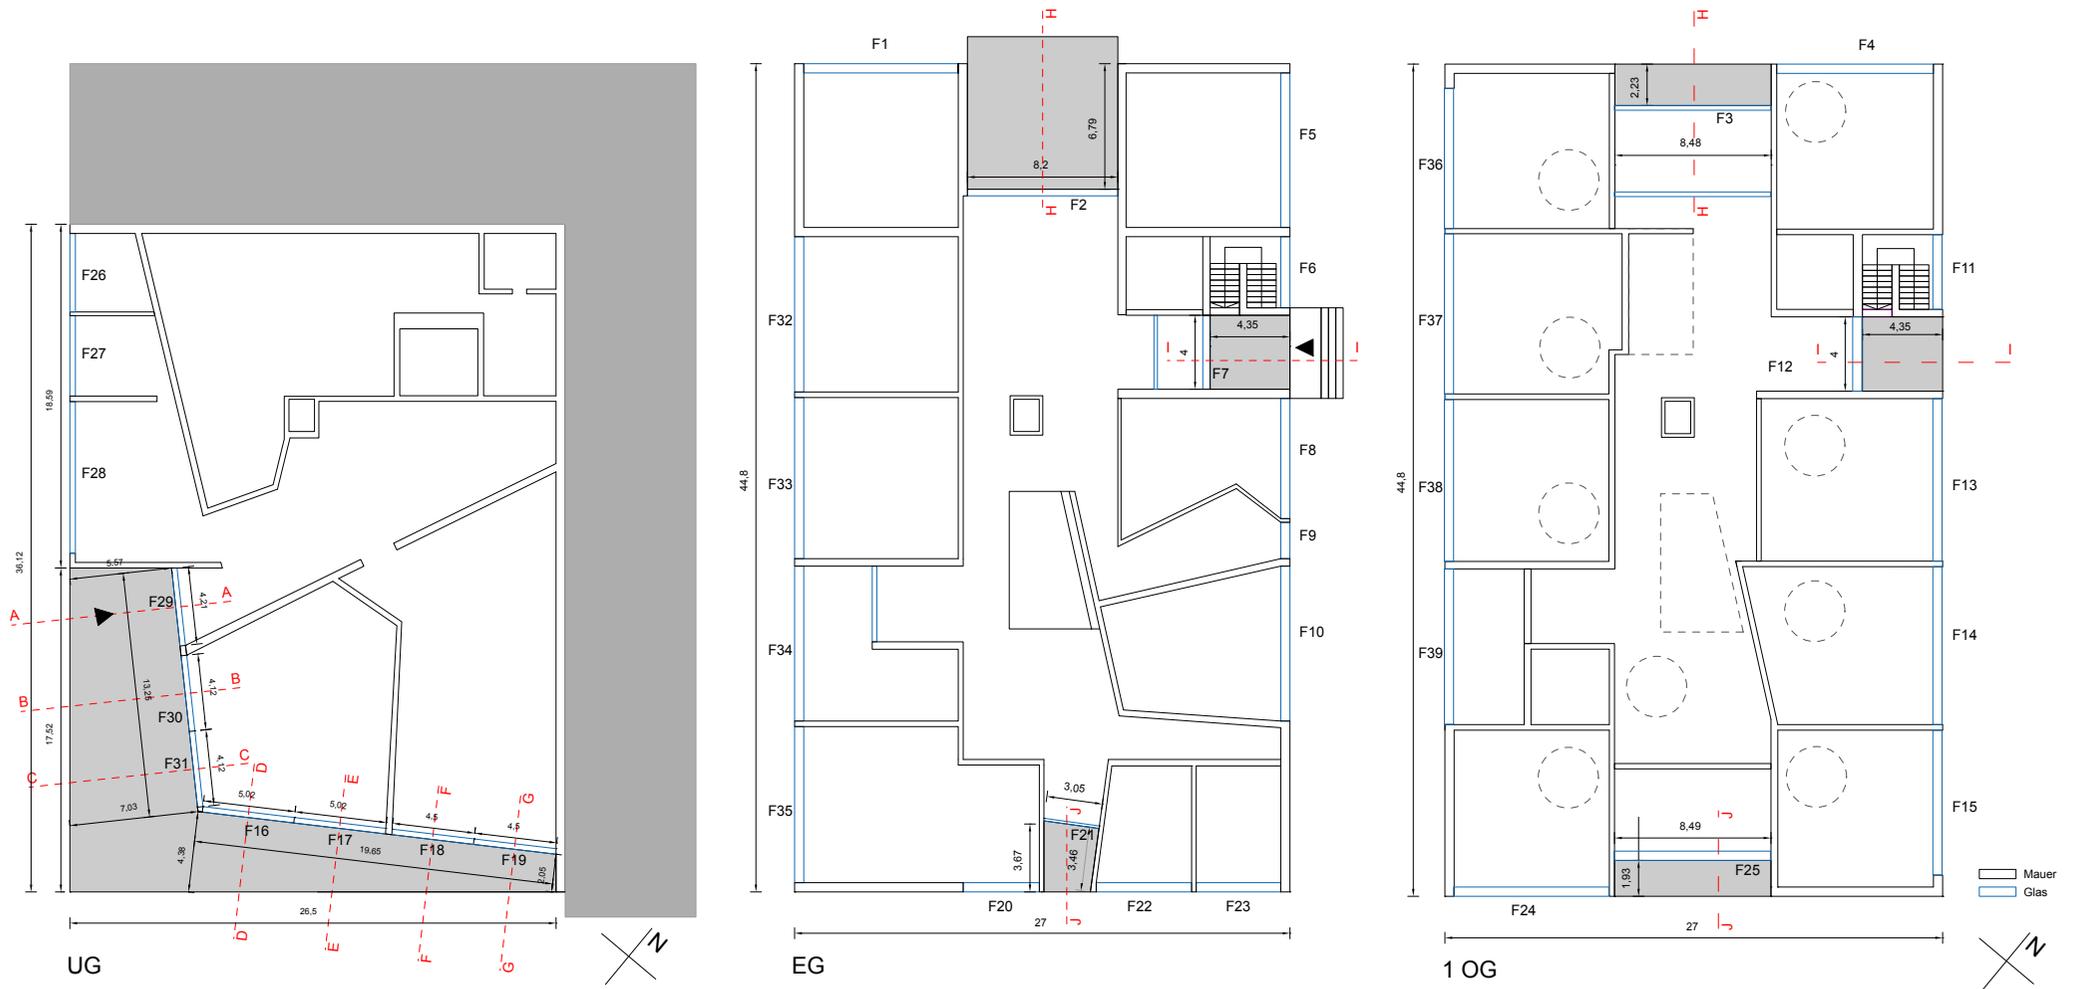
Grundrisse mit Achsen- und Fensterbezeichnungen M | 1:400
